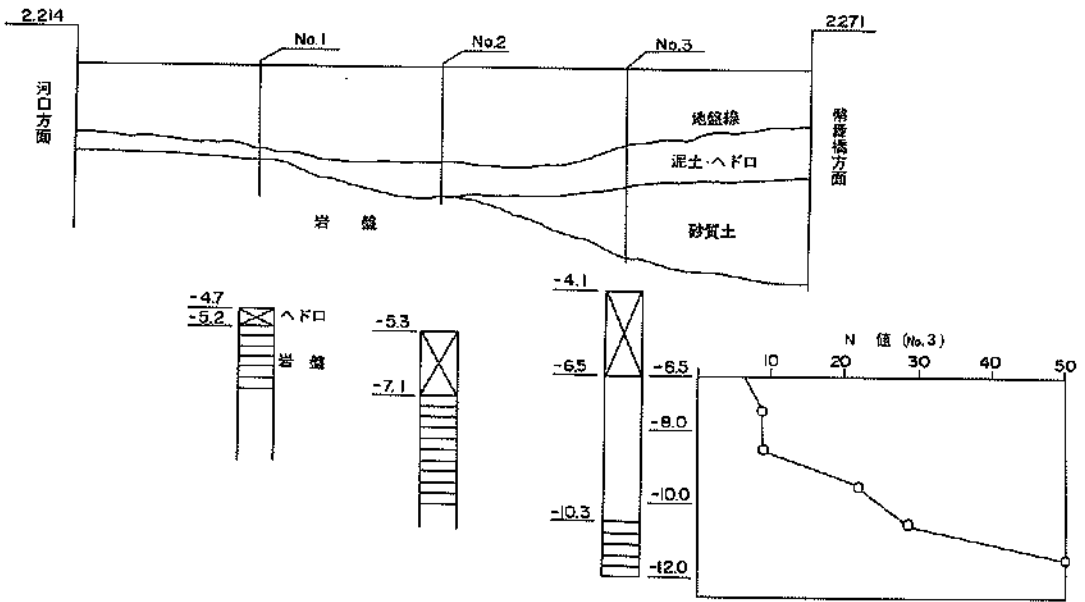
土質柱状図 (入舟地区, ①岸壁(-7.5m))
